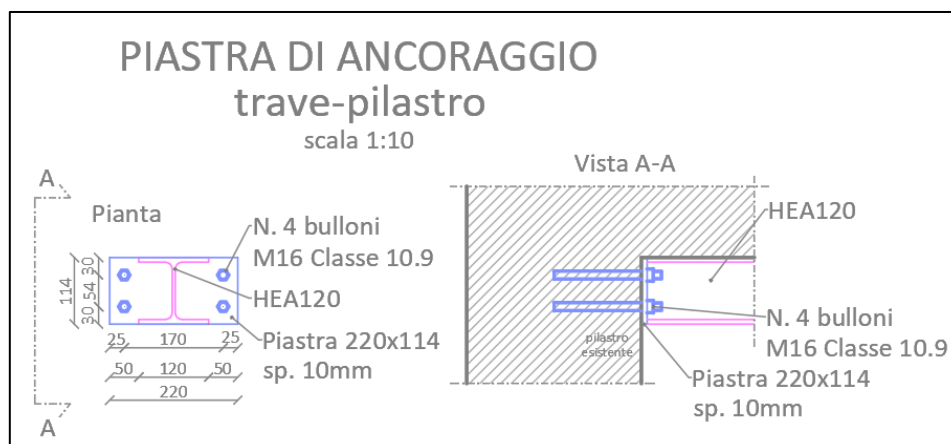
Particolare piastra di ancoraggio per aggancio trave – pilastro
